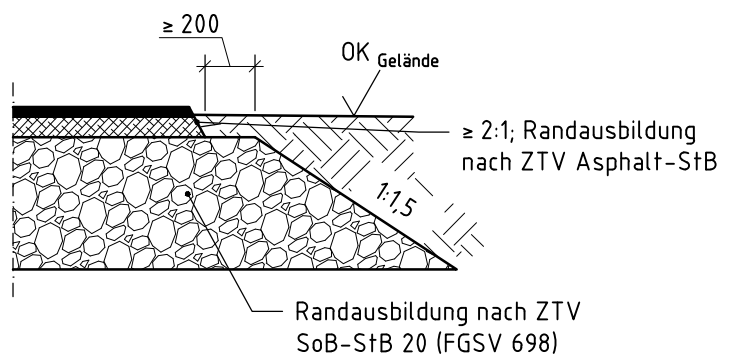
Detail Randabschlüsse für Wartungswege nicht höher als der Bauklasse Bk0,3 ohne Randeinfassung, Variante „Asphaltdecke“.
